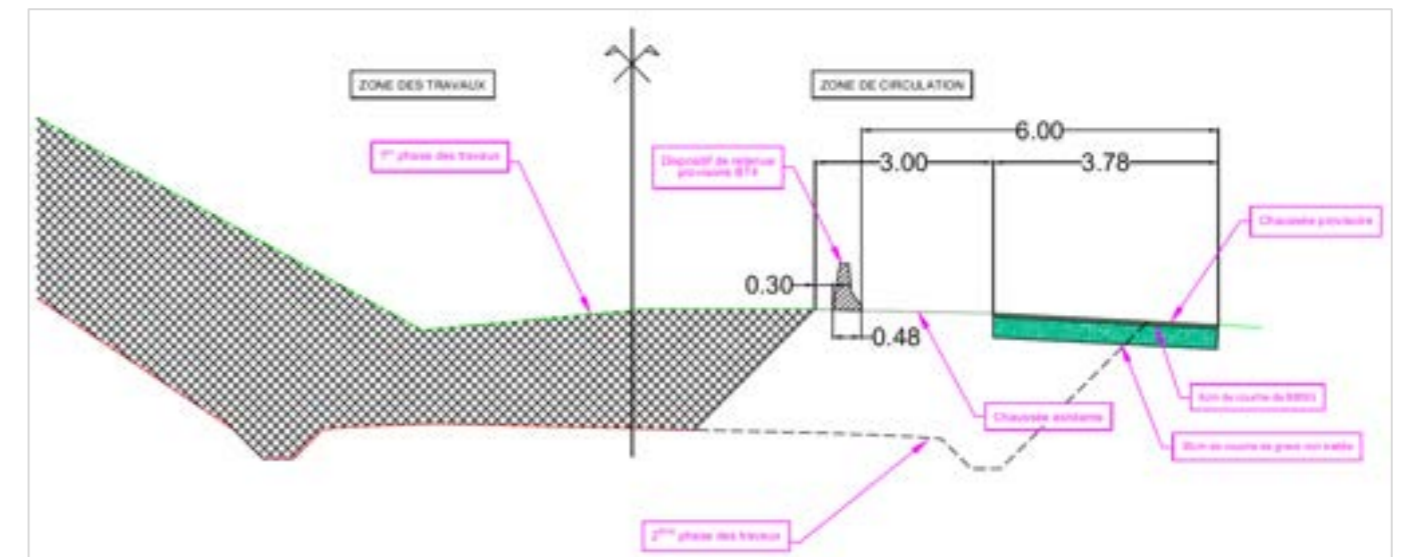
Coupe transversale - Zone de travaux / circulation en phase n°1 en remblai
